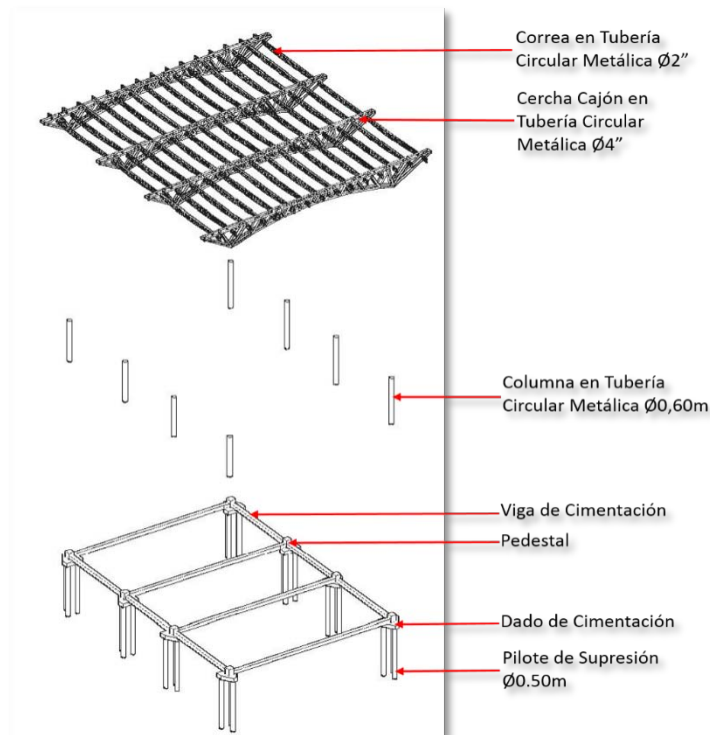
Axonometría de Elementos Constructivos Edificio 1
